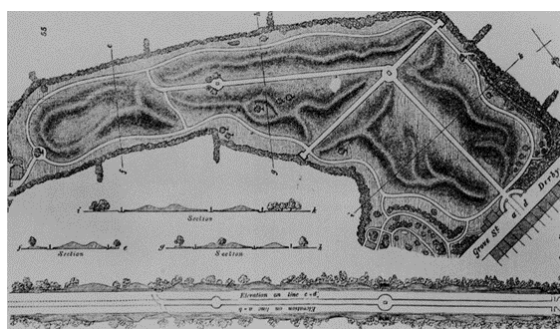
J. Loudon, planimetria dell'Arboretum a Derby, 1839-1840.
